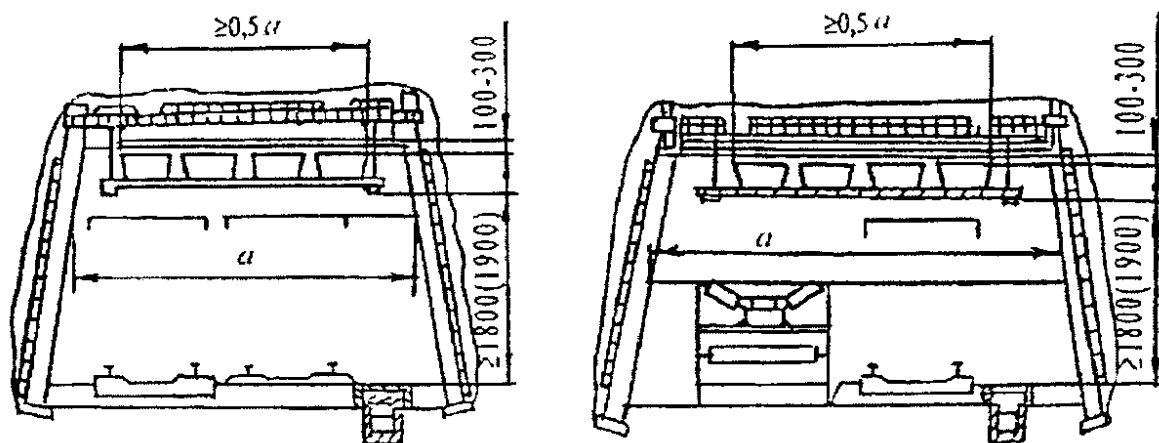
Схема установки водяных заслонов в выработках, закрепленных железобетонными стойками и шарнирно-подвесными верхняками
